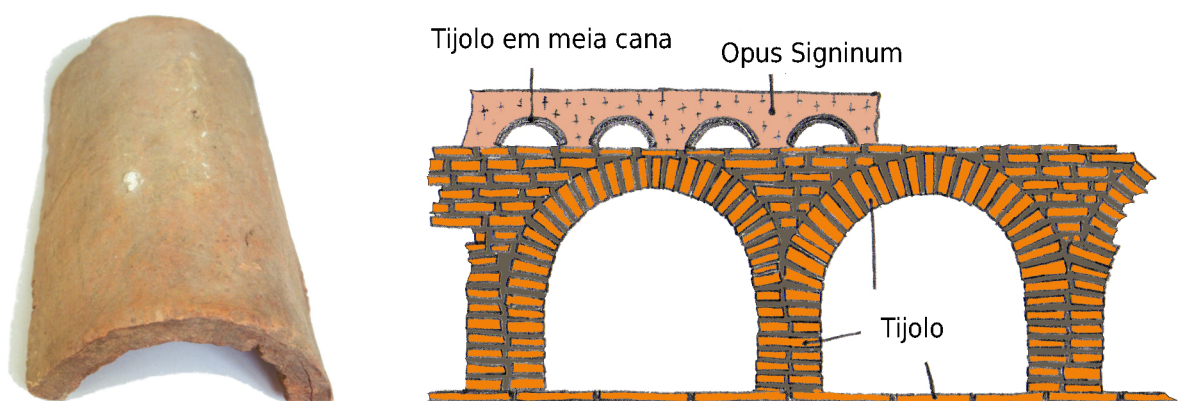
e 41 – Tijolo em forma de meia-cana. Representação da aplicação desta tipologia na construção em *Conimbriga* (Termas do Aqueduto).
